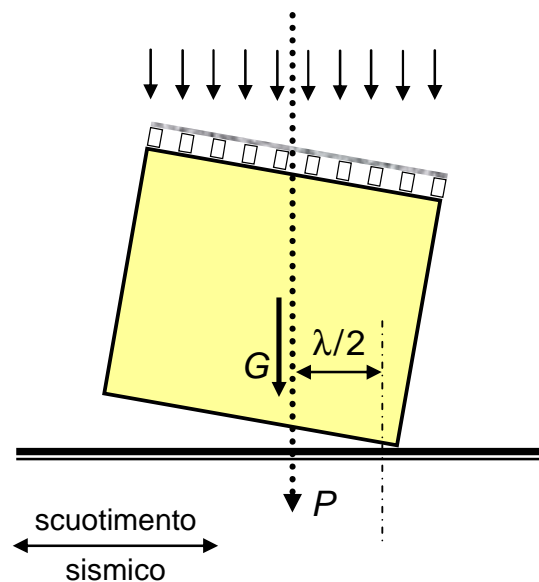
b*. Il muro di figura *a* è assoggettato a un'azione sismica parallela al muro stesso, che lo fa vibrare in condizione di meccanismo rotazionale nel proprio piano (piano verticale). Il perno della rotazione è localizzato sul vertice murario, per semplicità. Lo schema localizza le tensioni, dunque, anziché diffonderle (p. es. come stress-block). I travetti sono indipendenti tra loro e perciò assecondano la vibrazione del maschio murario. Conseguentemente, il solaio segue la rotazione del muro che lo porta. I travetti rimangono dunque nella loro sede naturale. In condizione ruotata, quindi, il solaio continua a scaricare la stessa risultante, nello stesso punto del muro, che in campo statico. Pertanto, il momento antagonista alla rotazione dato dal solaio vale: $P\lambda/2$. A ciò si aggiunge il momento antagonista alla rotazione dato dal peso proprio, G , del muro: $G\lambda/2$. Si precisa che si sta considerando un'oscillazione di ampiezza al più moderata, e quindi i bracci delle forze spostate pressoché coincidono con i bracci delle forze indeformate.
